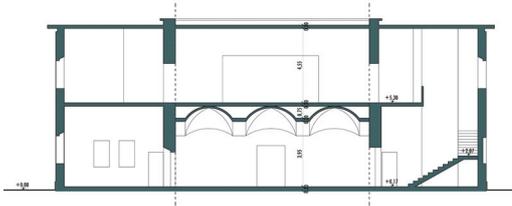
Sezione longitudinale A-A del Museo della Ferrovia/ area ristoro
